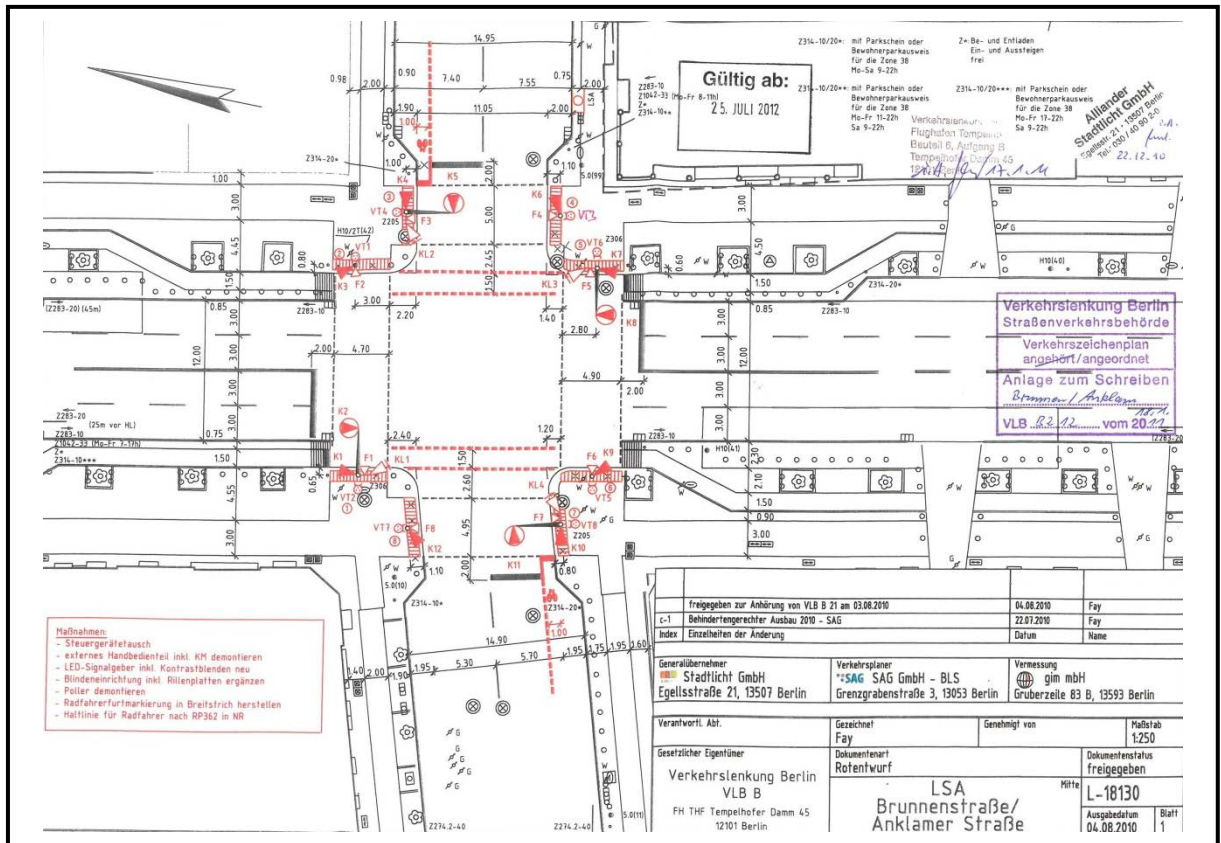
LSA 18130 Brunnenstraße/ Anklamer Straße
